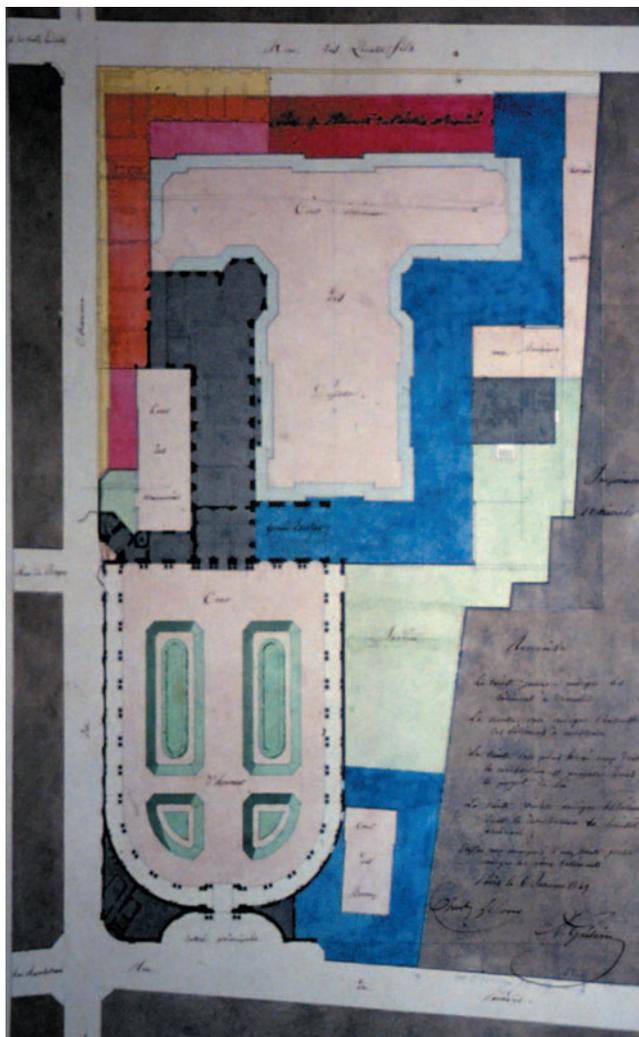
Plan général des bâtiments signé par Charles Lelong et A. Gréterin le 6 janvier 1849, coloré pour plus de lisibilité: en jaune, bâtiments à démolir; en rose, à construire; en rose foncé, construction proposée dans le projet du roi; partie de bâtiment dont l'exécution est demandée; en gris, les vieux bâtiments; en violet-bleu, les constructions bientôt achevées, dont les dépôts dits Louis Philippe qui font pendant à l'hôtel de Soubise dans la cour des dépôts (Archives nationales, ABVB7, *plan d'un projet concernant l'agrandissement des bâtiments des Archives Nationales*).
